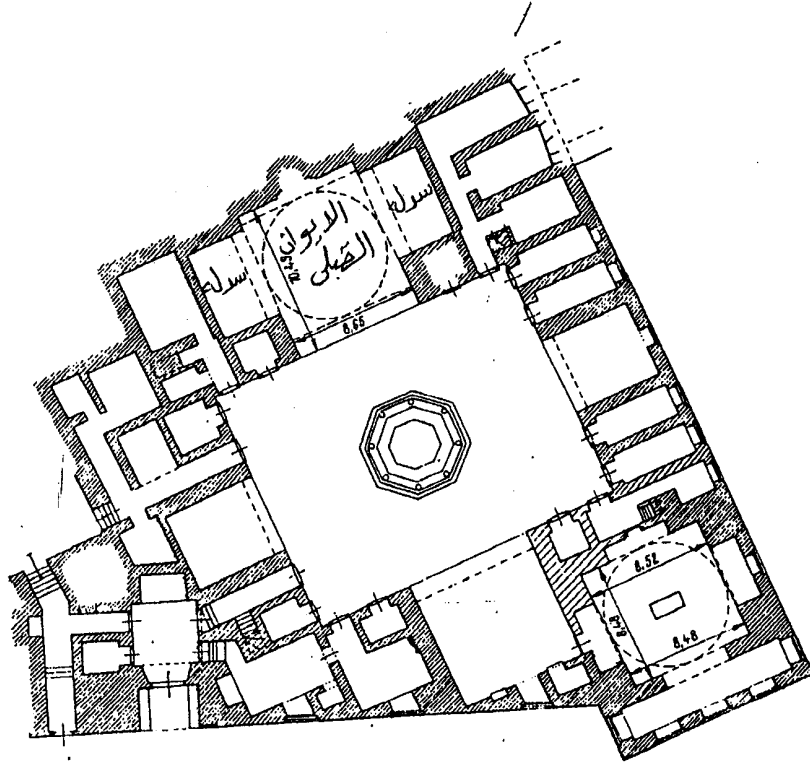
مسقط أفقي للمسجد بقلعة قايتباي بالأسكندرية
